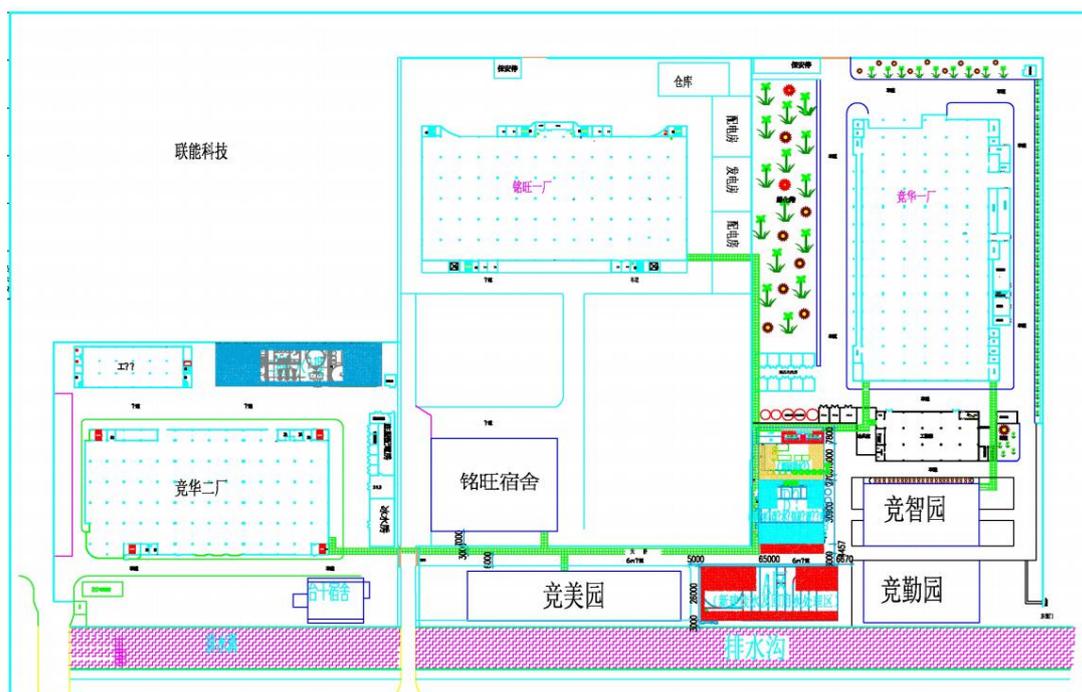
竞华电子(深圳)有限公司平面布置图
